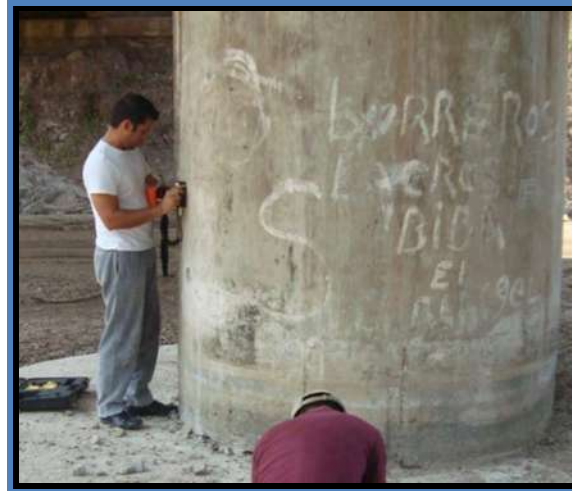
Determinación de la profundidad de la armadura y el diámetro de la varilla, en Columna del Puente “El Cayaco”, Lázaro Cárdenas. (04/JUN/2011).
